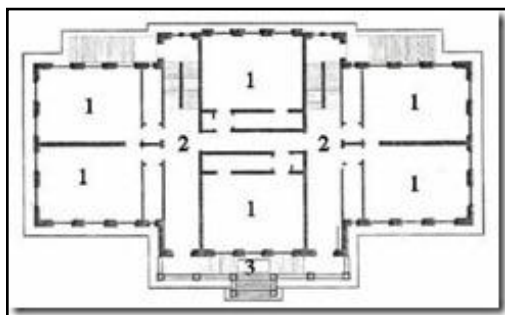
Exemplo de planta baixa e organização funcional de escola
